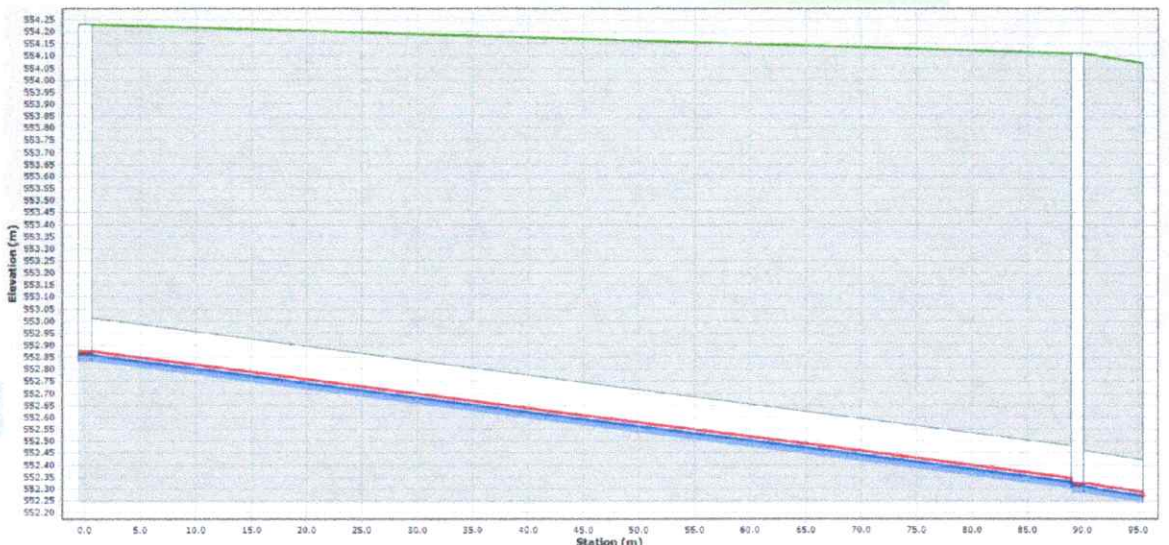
Perfil tramo PZ 13 - EXIST 7
